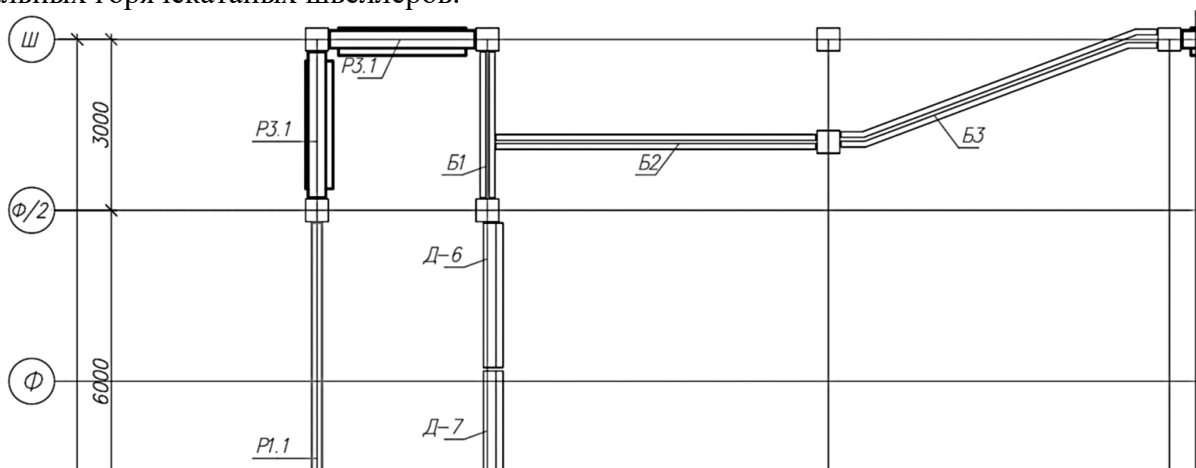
Фрагмент раскладки ригелей с металлическими балками на 2-м этаже
